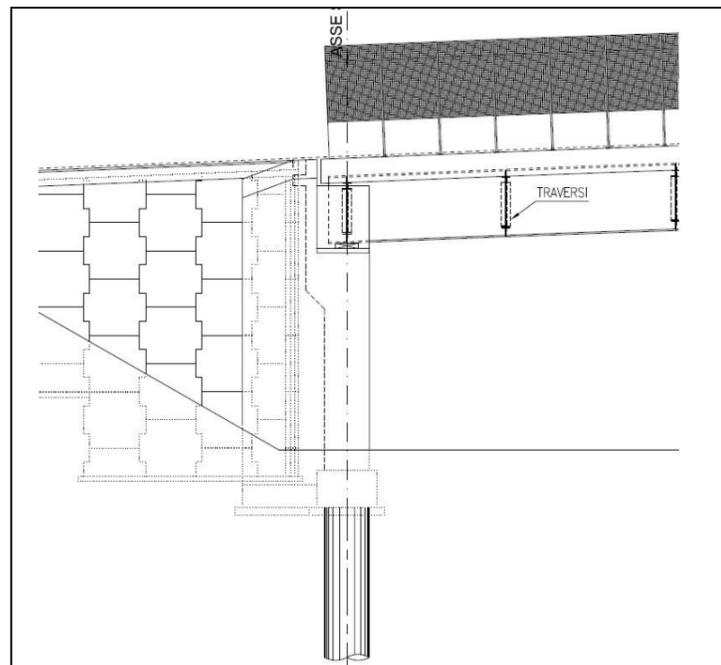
Particolare della fondazione della spalla dei cavalcavia
